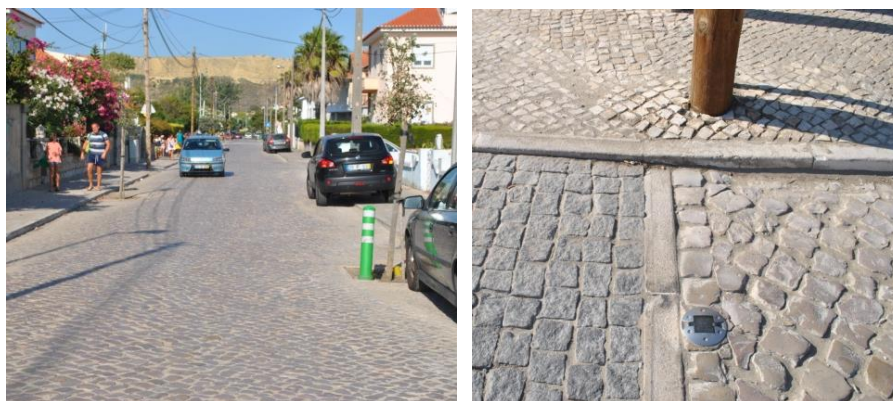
e 28. Bairro de S. João de Caparica, Almada
